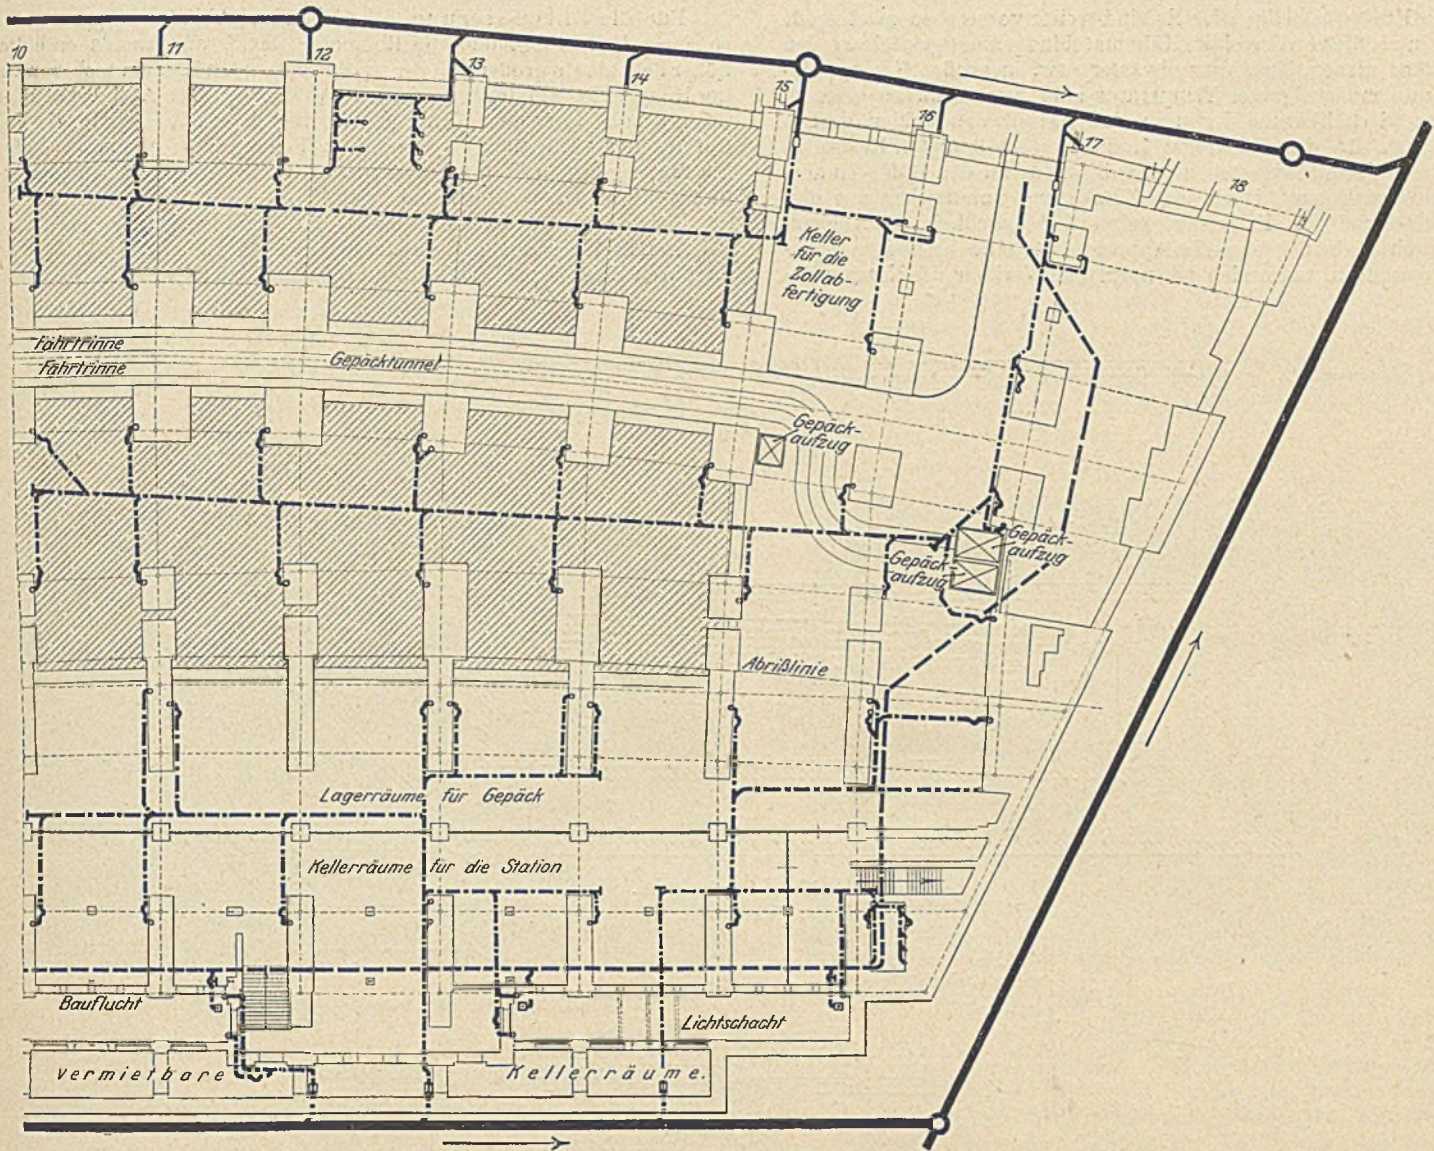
Abführung des Dachwassers in die Spree. Grundriß.
